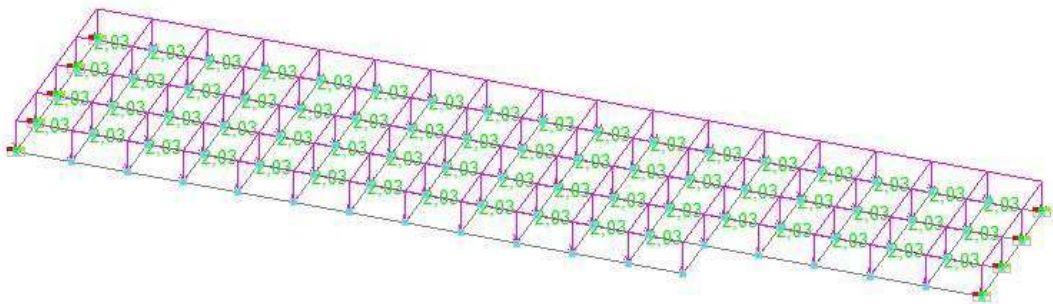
Схема загрузки плиты нагрузкой от веса пола
